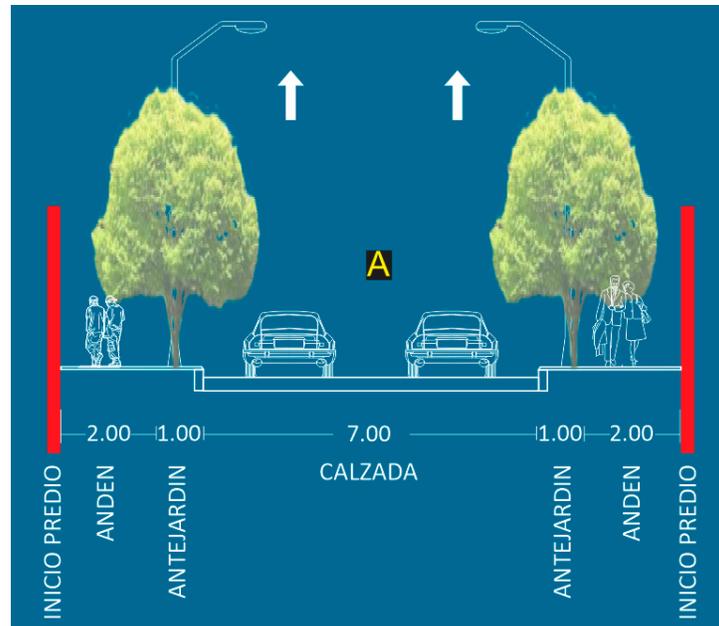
Perfiles Viales aplicables al sector. Fuente: POT Floridablanca 2018, elaboración propia.
